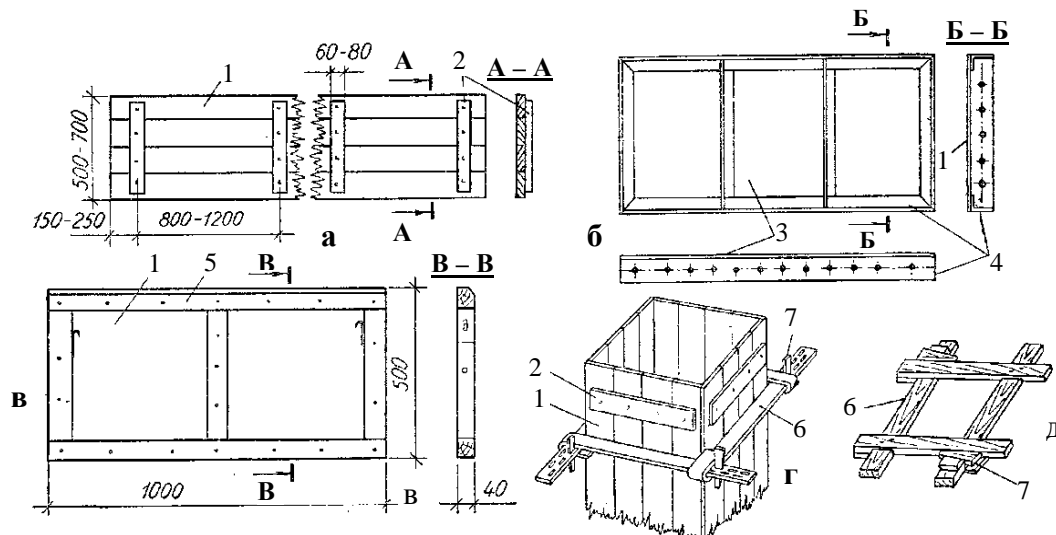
Елементи розбірно-переставної дрібнощитової опалубки: а – дошковий щит на зшивних планках; б – щит із сталевих листів з каркасом; в – щит з водостійкої фанери; г – сталевий хомут; д – дерев'яний хомут; 1 – щити опалубки; 2 – зшивна планка; 3 – сталевий лист; 4 – каркас з куточків; 5 – каркас з дерев'яних брусків; 6 – гілки хомути; 7 – клини
